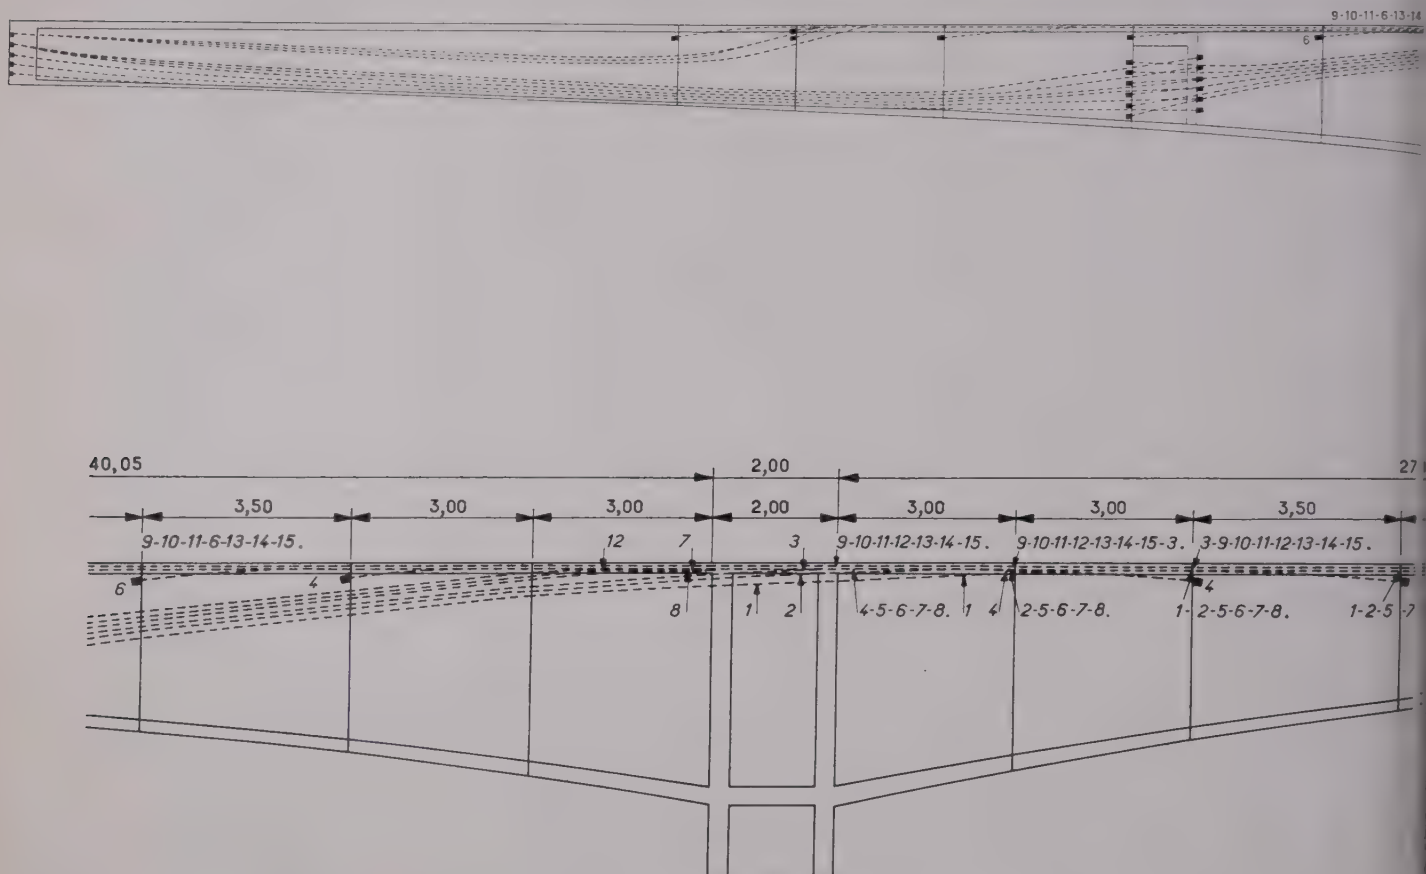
Coupe longitudinale du pont et détail de ferrailage sur appui.
